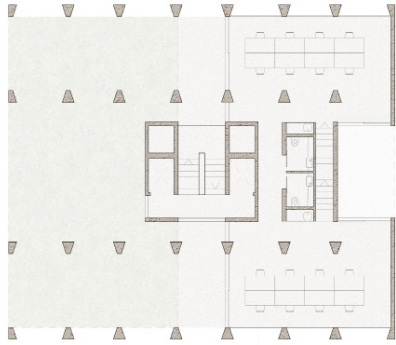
Planta Piso Térreo, Workshop, Março 2020
